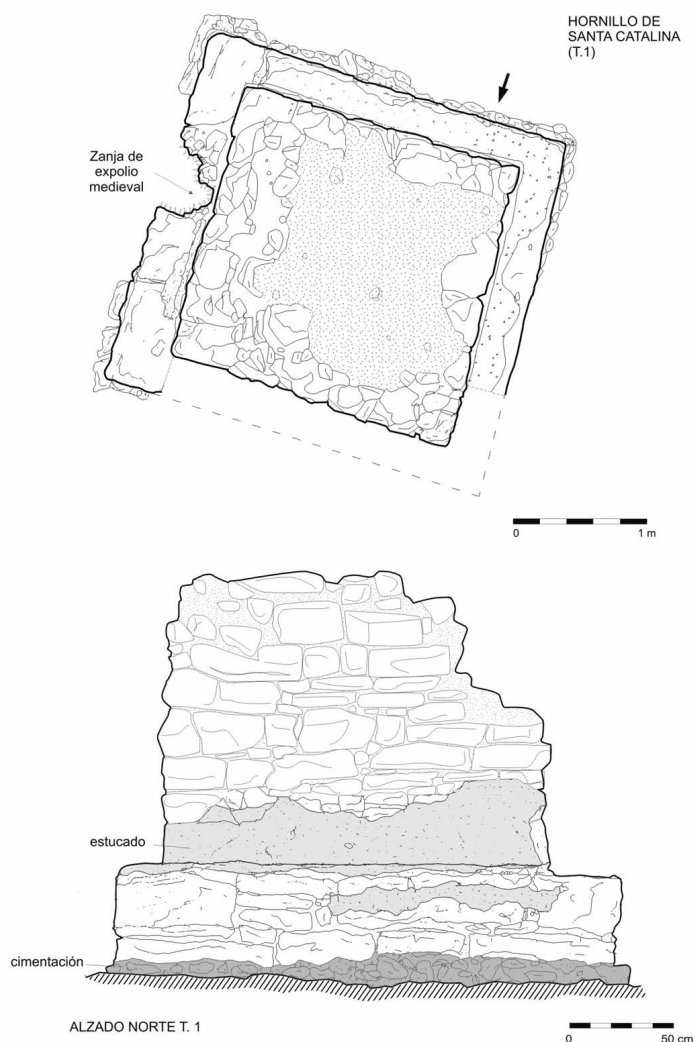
Planta y alzado norte del “Hornillo de Santa Catalina”.
